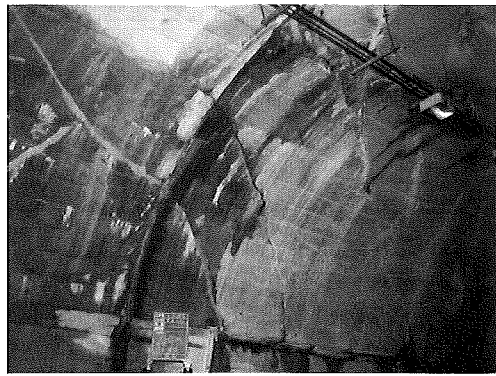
荒谷トンネルの被害状況(斜め方向ひび割れ)
